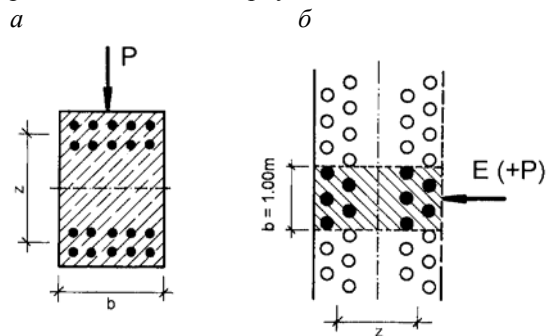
Оценка несущей способности армирующей стены с корневидными сваями по аналогии с железобетонной балкой: а – железобетонная балка с напряженным и сжатым стальным стержнем; б – армирующая стена из корневидных свай, нагруженная горизонтальным давлением грунта E и грузом здания или дорожного транспорта P ; ширина $b = 1,00$ м
